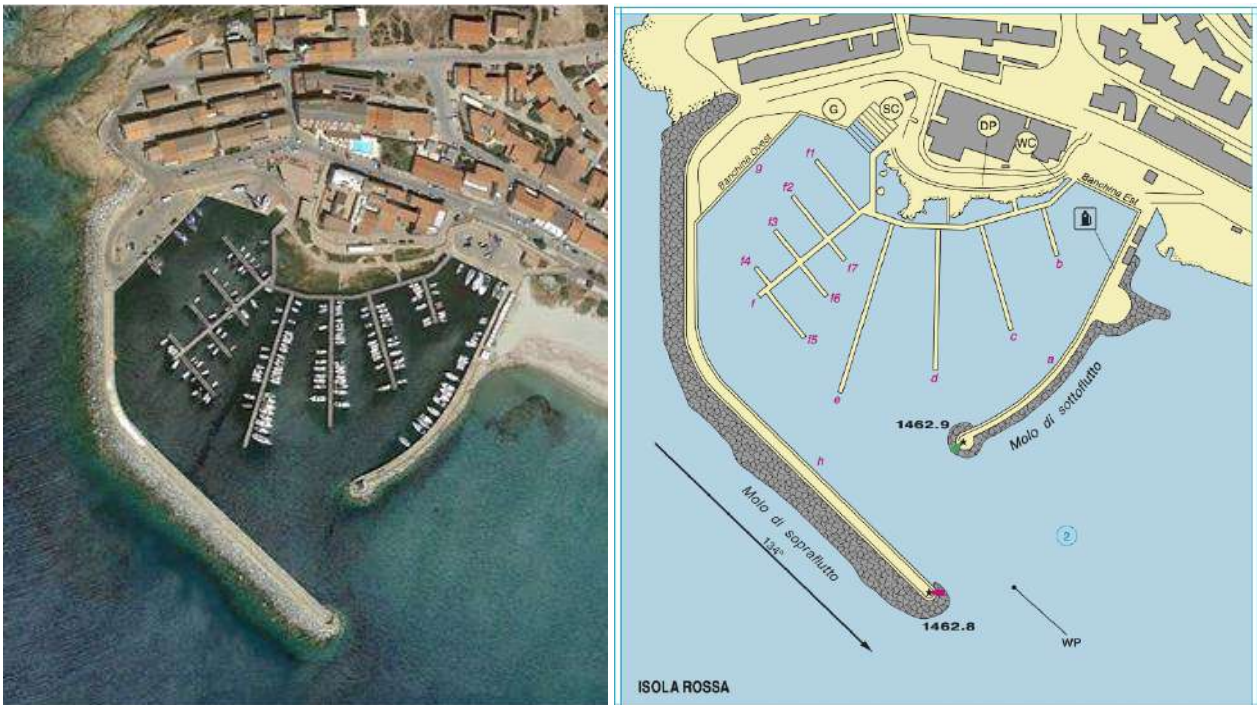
Porto di Isola Rossa - vista aerea e planimetria
